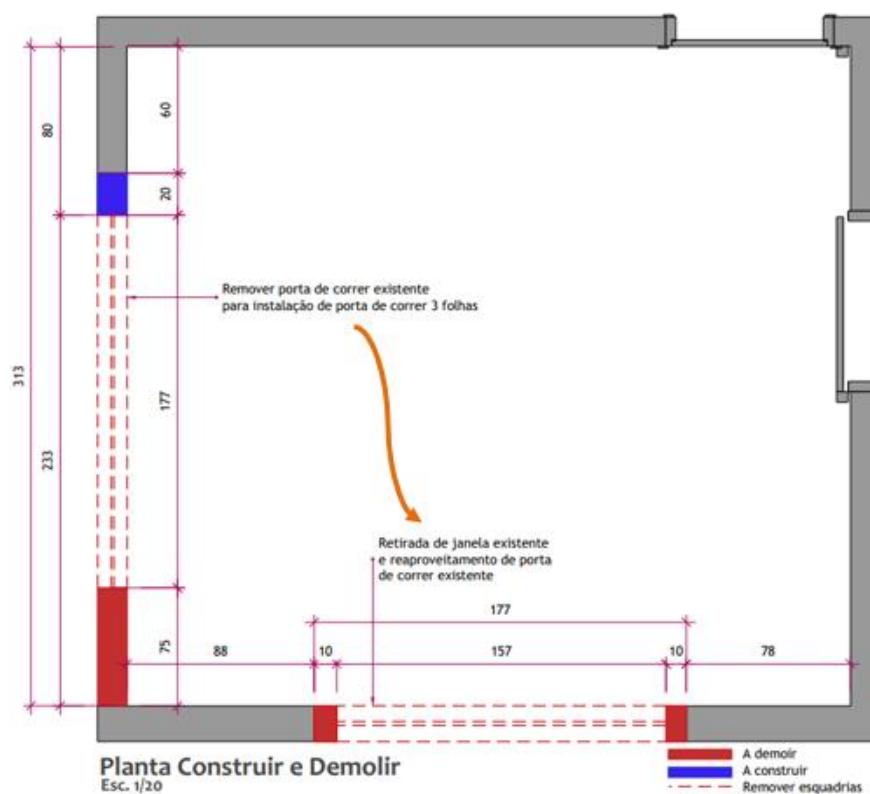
Planta de construir e demolir, com reaproveitamento de porta de correr
